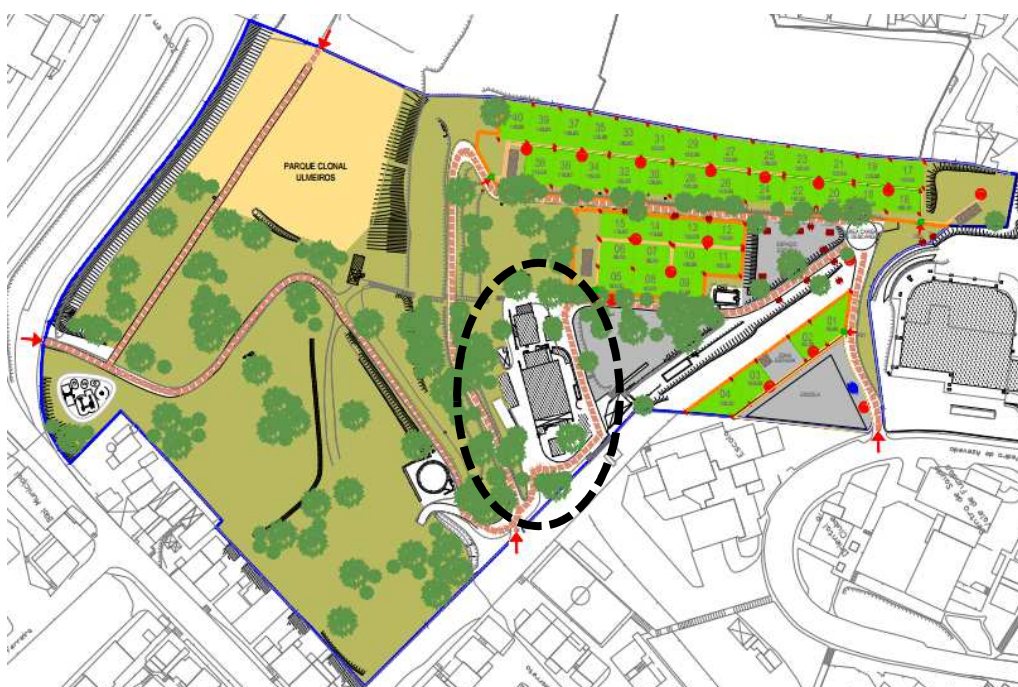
Planta da Quinta das Flores, com edificado de estudo
